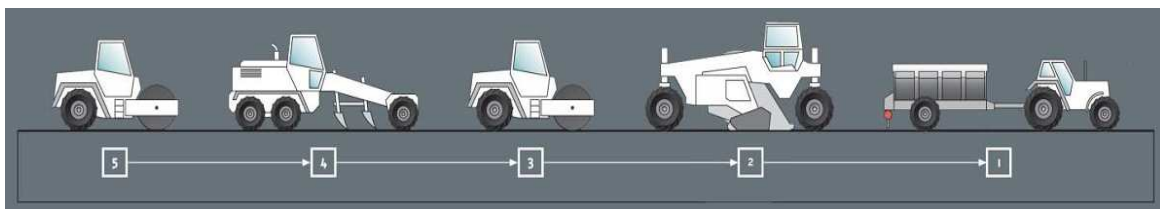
Execução da estabilização por via seca (Cruz, 2008).
